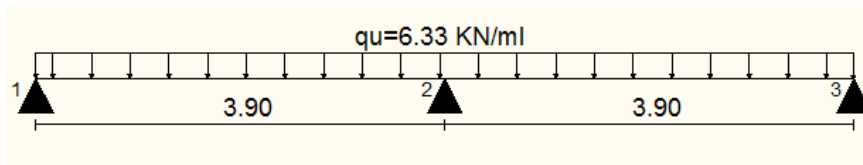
schéma statique de la poutrelle type 1 à l'ELU
